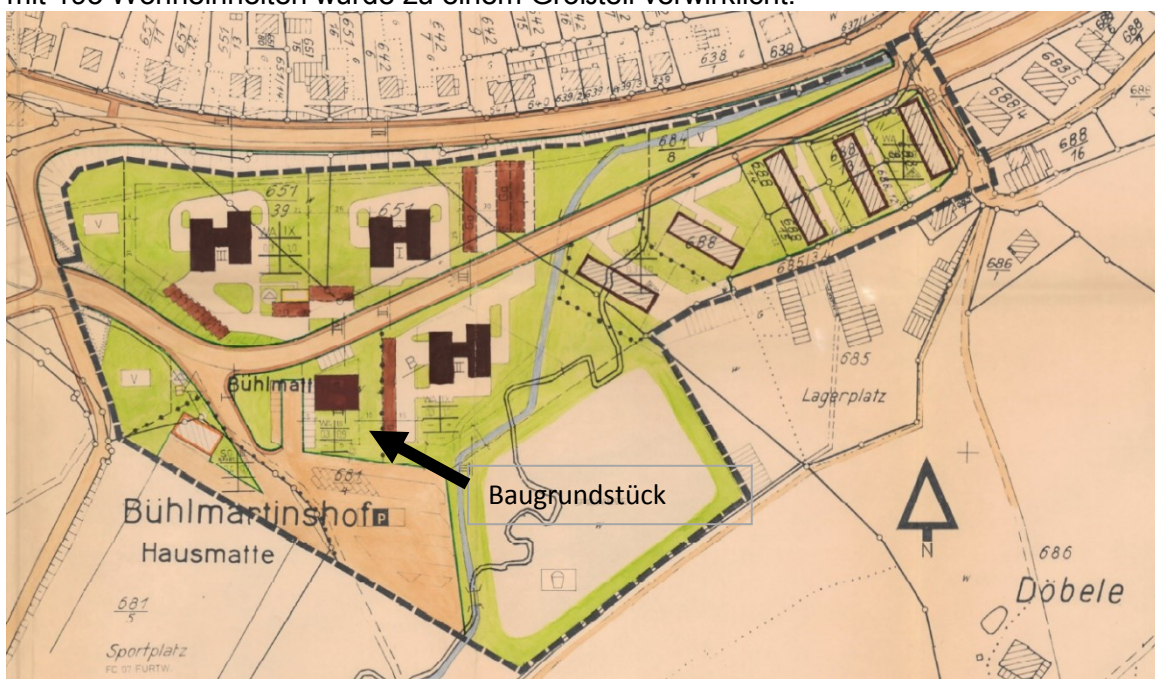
Abb. I: Auszug Bebauungsplan Gewann Breg (Ursprungsfassung)
